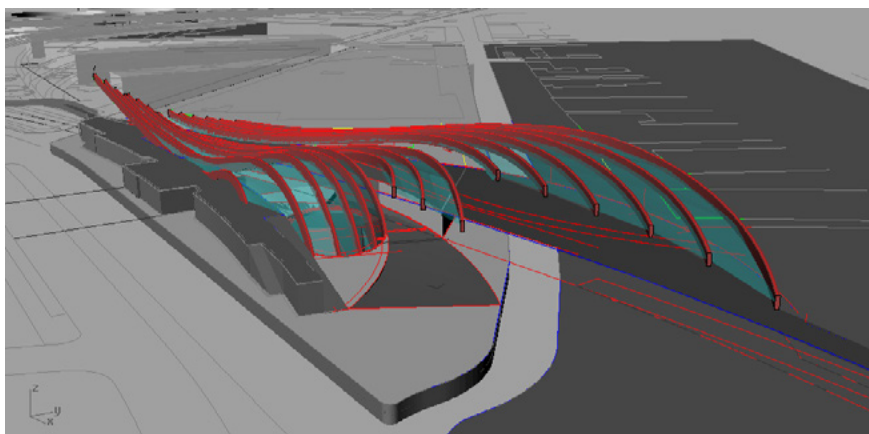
Imagen Objetivo (Sólo vigas Longitudinales).
